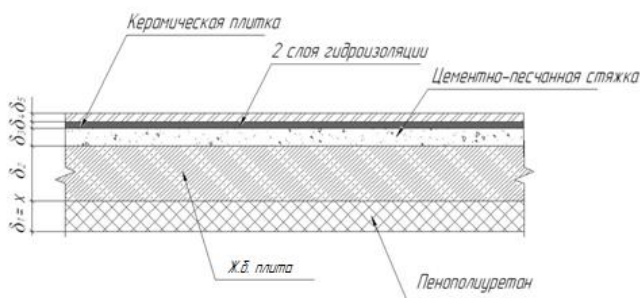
Состав конструкции перекрытия над подвалом
